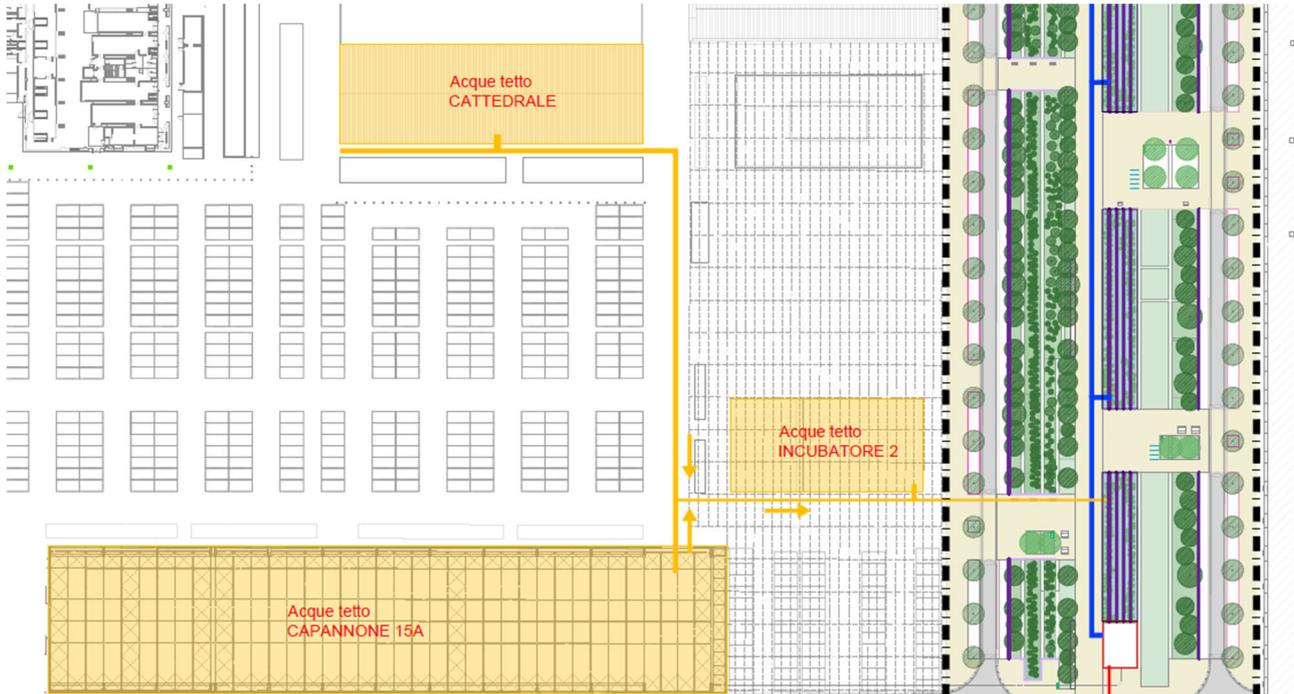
Estratto planimetria reti fognarie: Rete di raccolta acque bianche da coperture
